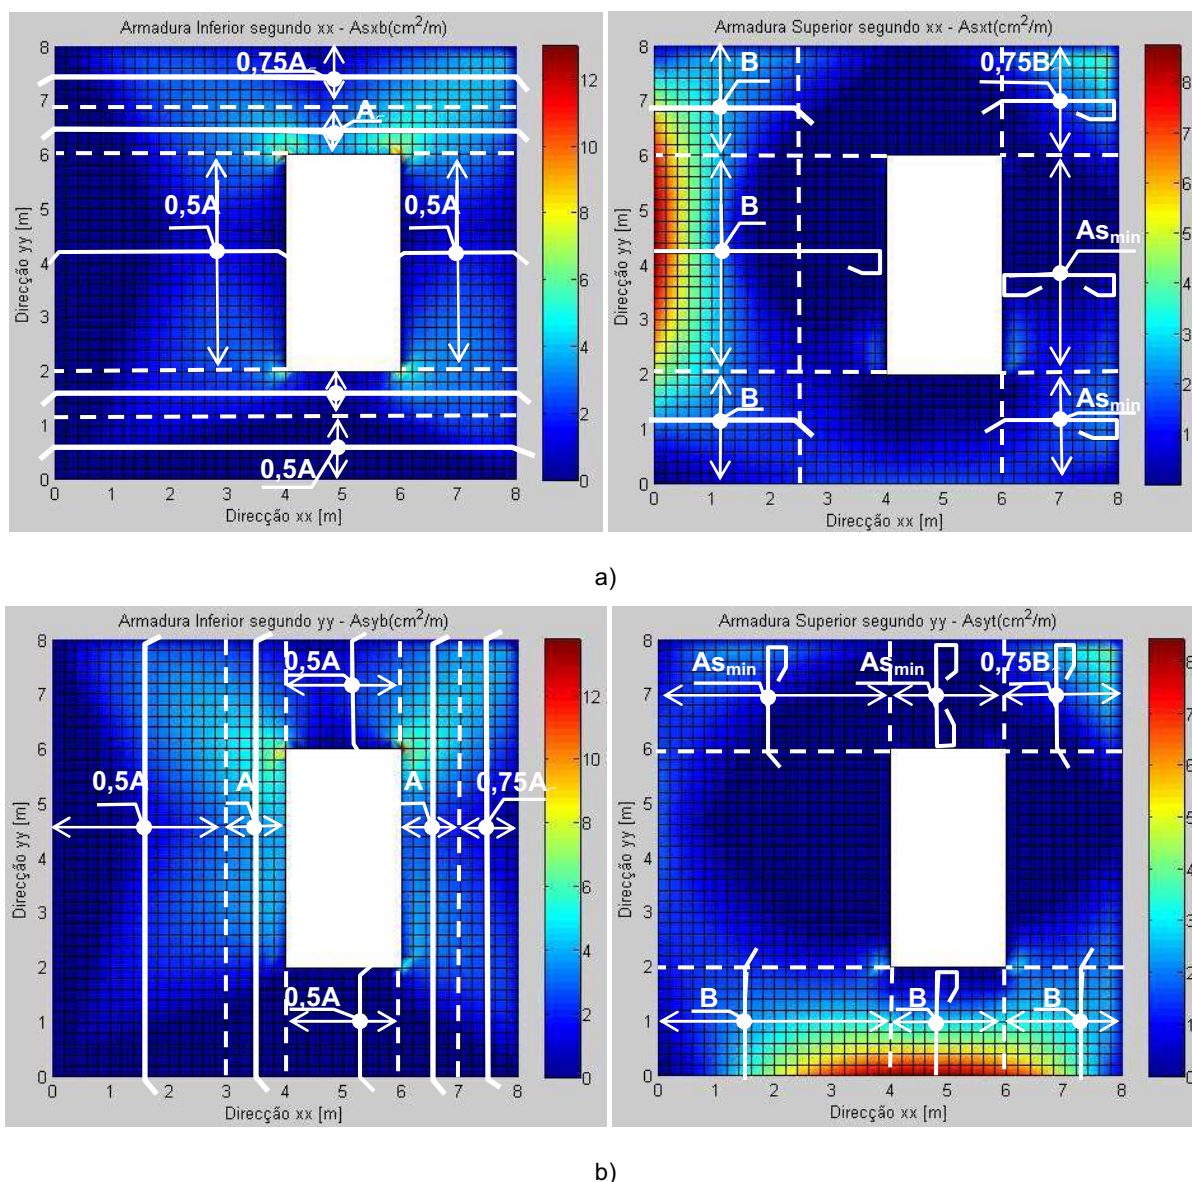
a) Armaduras segundo a direcção x; b) Armaduras segundo a direcção y
